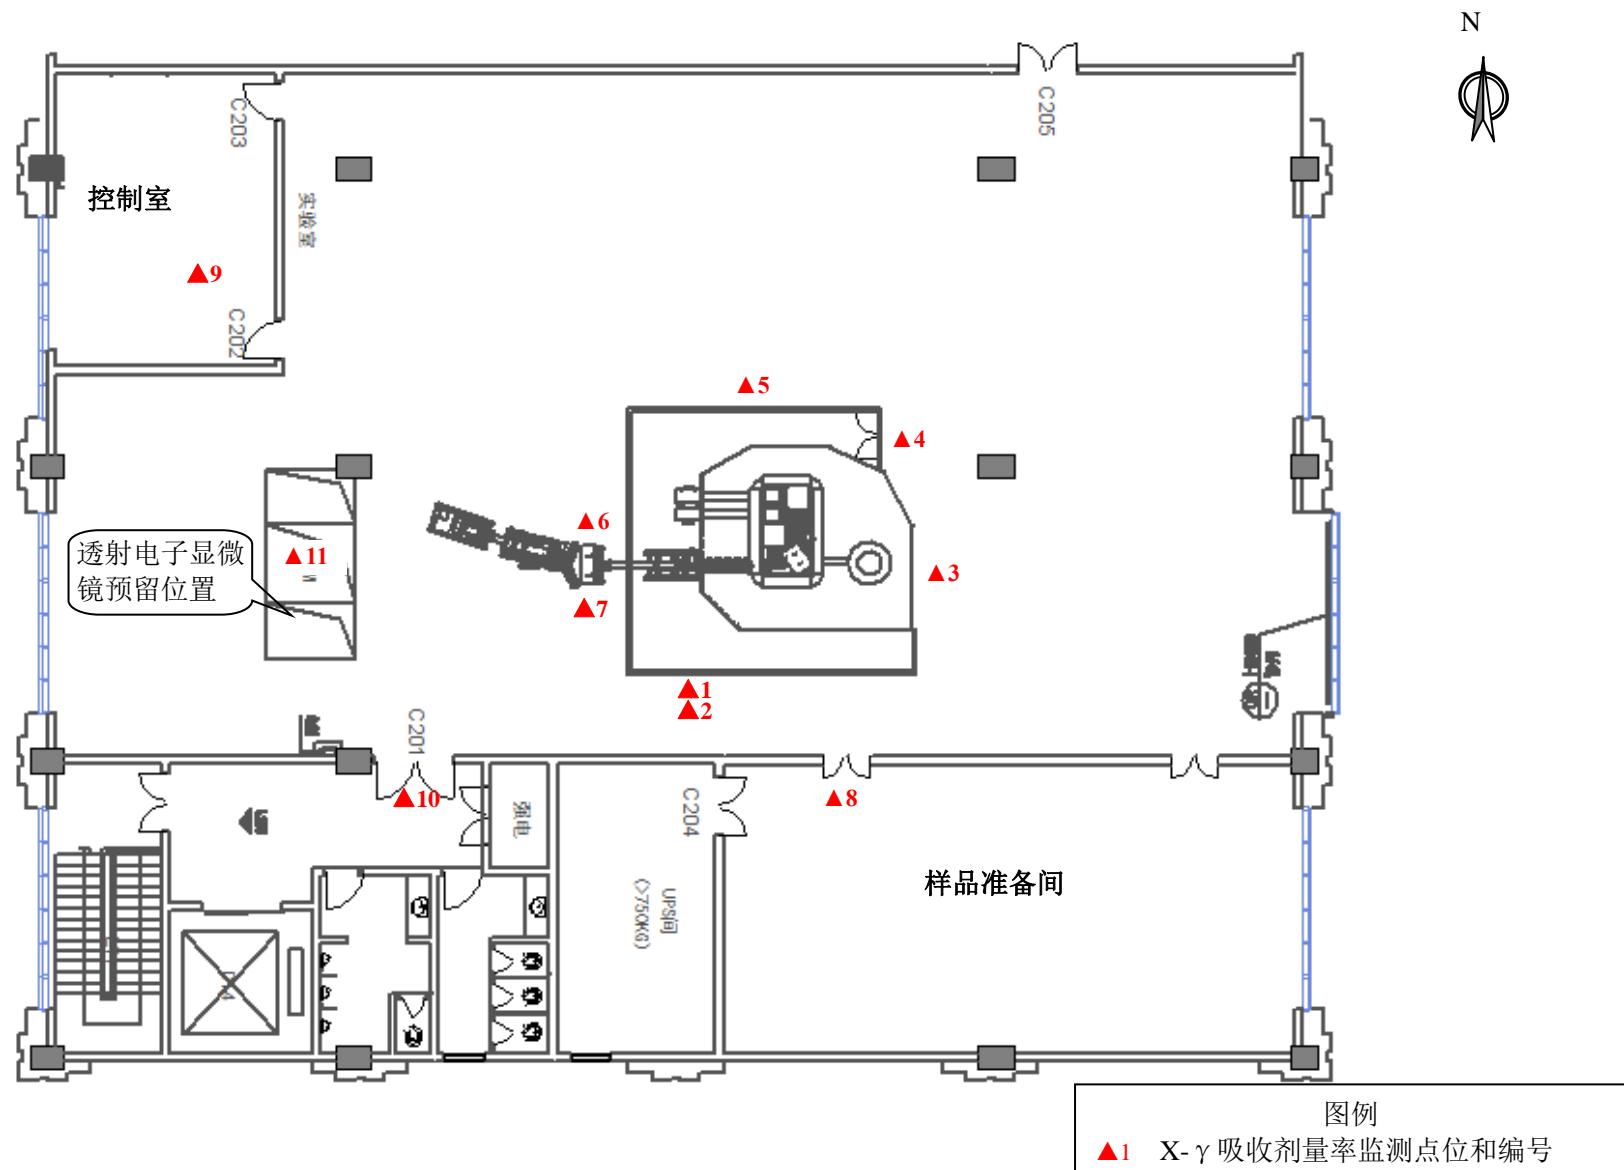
能源学院二楼静电实验室平面布置简图及监测点位图
